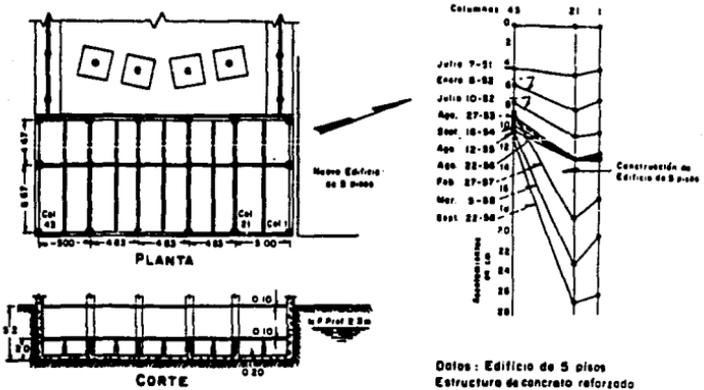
Influencia de las fallas de talud y de fondo de una excavación en una cimentación parcialmente compensada
